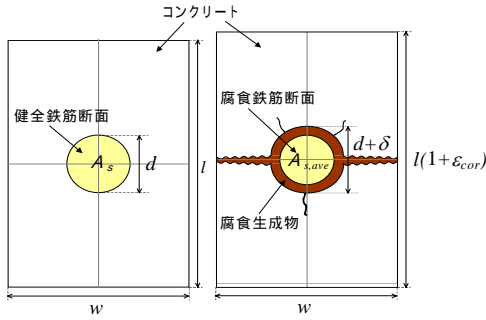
鉄筋腐食に伴うひび割れの模式図
